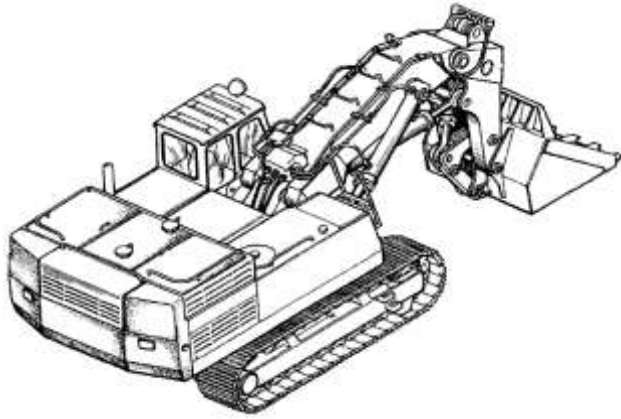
Загальний вигляд гідравлічного екскаватора з обладнанням «пряма лопата»
